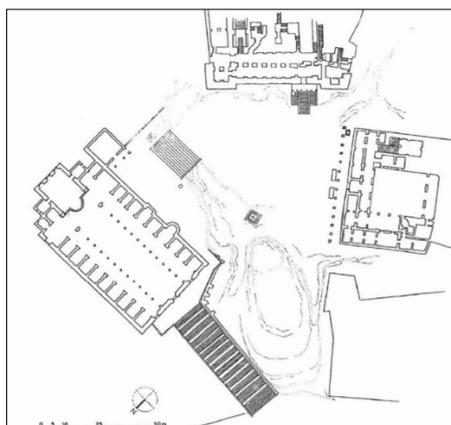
Campidoglio, pianta prima degli interventi di Michelangelo
